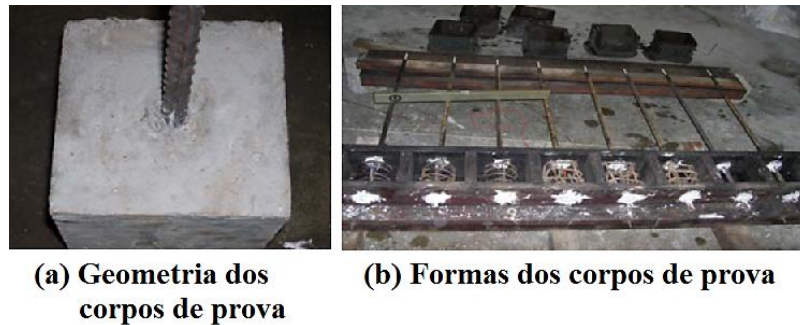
Processo de fabricação dos corpos de prova (HADI, 2008).
